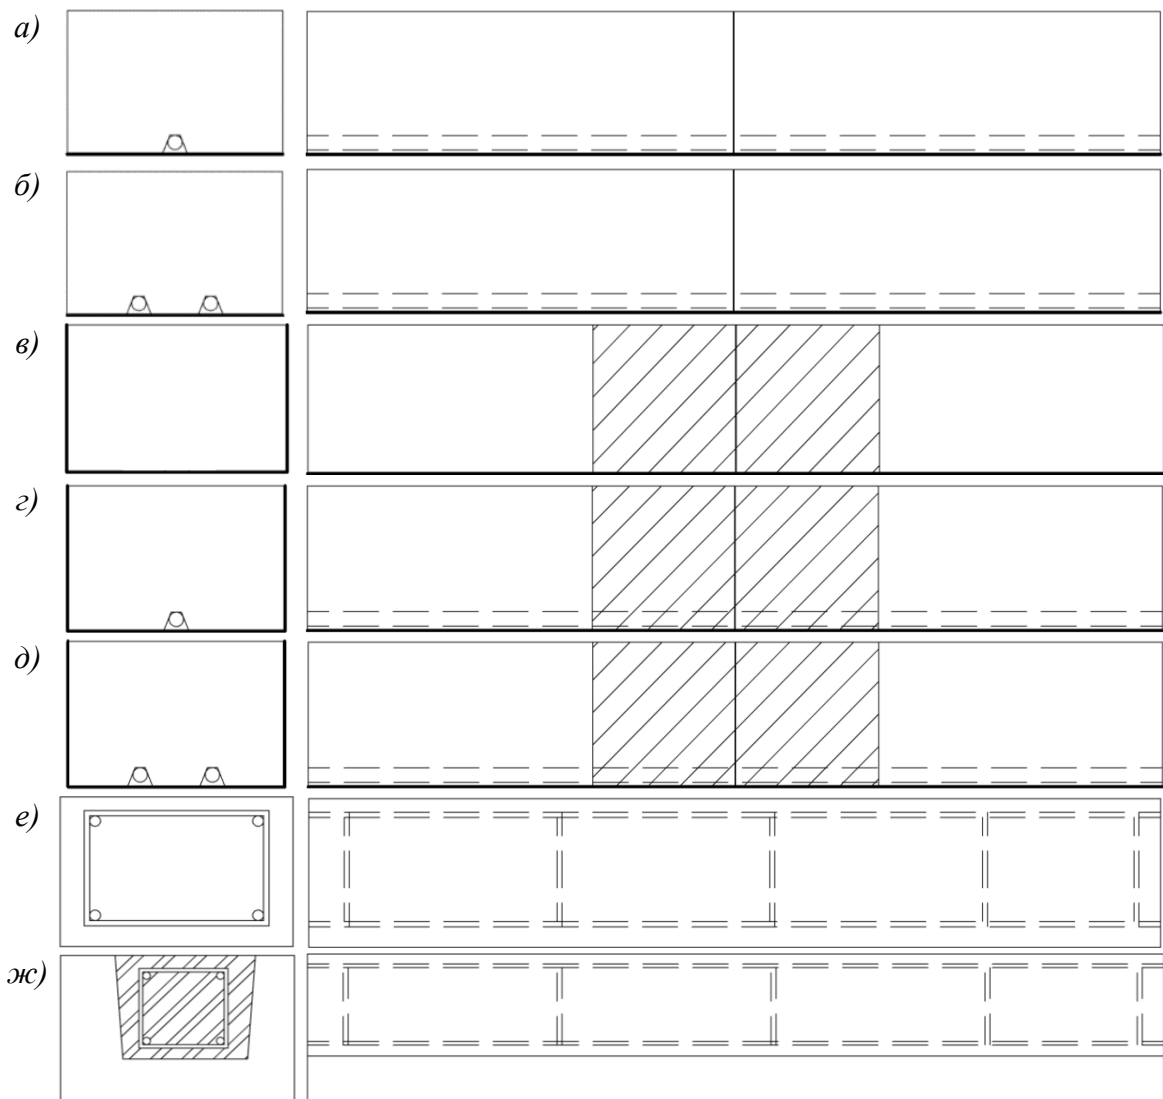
Поперечный разрез и общий вид фрагментов составных перемычек из газобетонных блоков для определения приведенного сопротивления теплопередаче:
